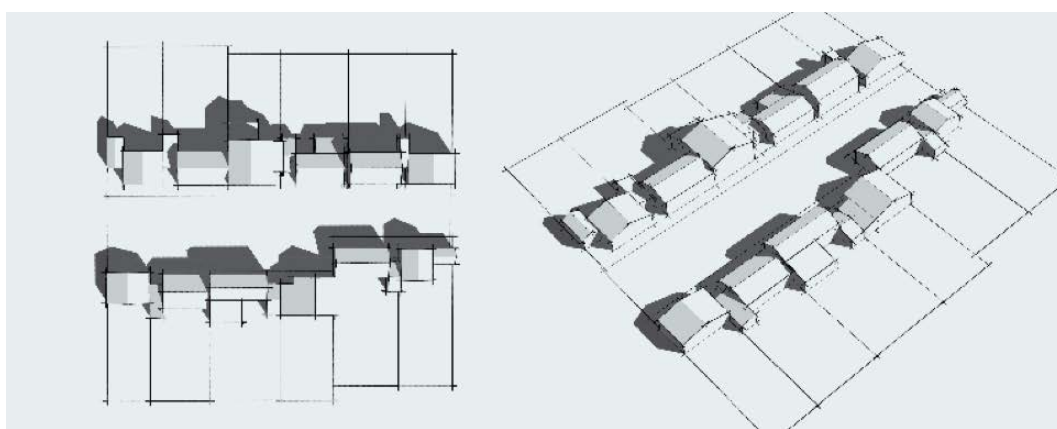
Alignement du bâti sur la voie : structuration de l'espace public (CAUE de Vendée, 2009, p.49)
